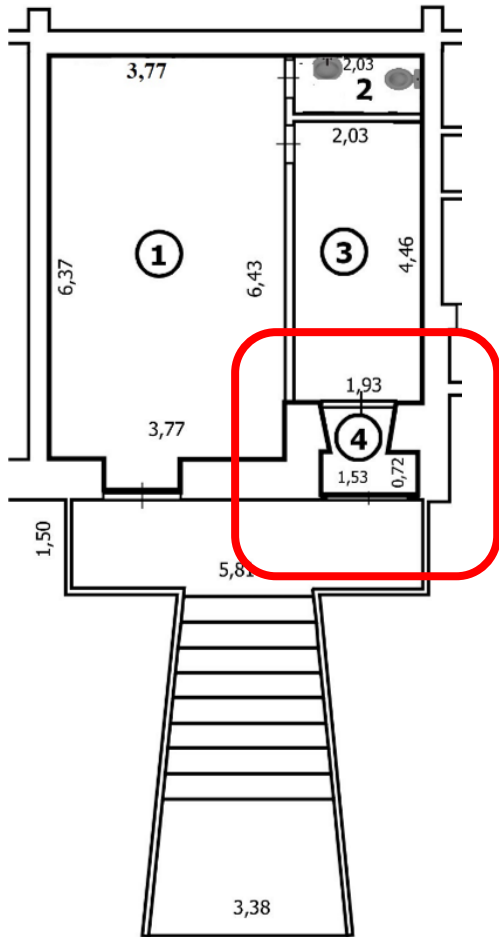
поэтажный план (см. конфигурацию помещения 4)
